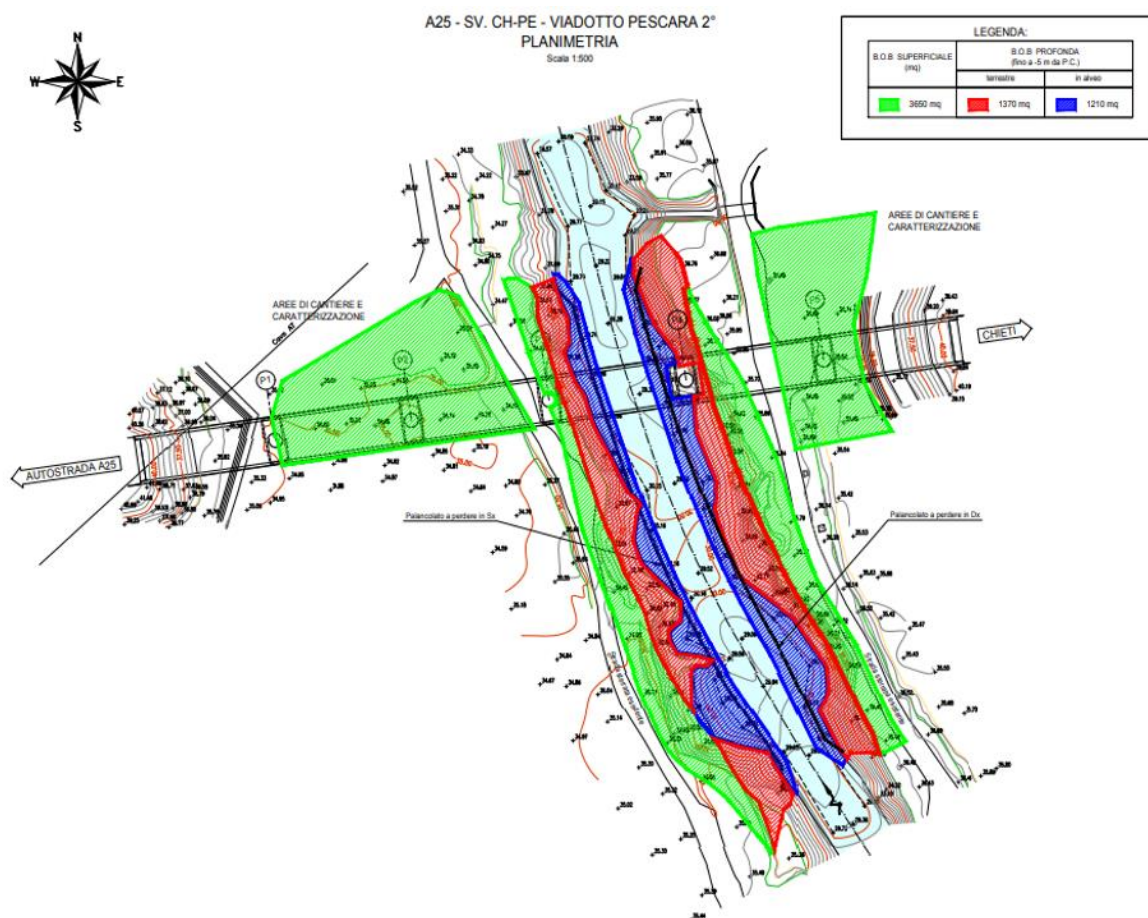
Planimetria delle aree interessate dalle diverse tipologie di bonifica da ordigni bellici²⁷
